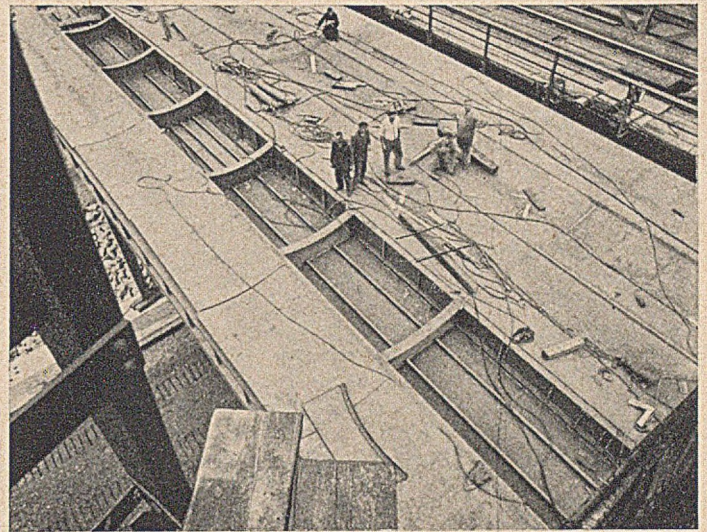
Unterführung der Reichsstraße Heilbronn—Böckingen auf Bahnhof Heilbronn (Brücke 1). Draufsicht auf die Fahrbahnkonstruktion.
